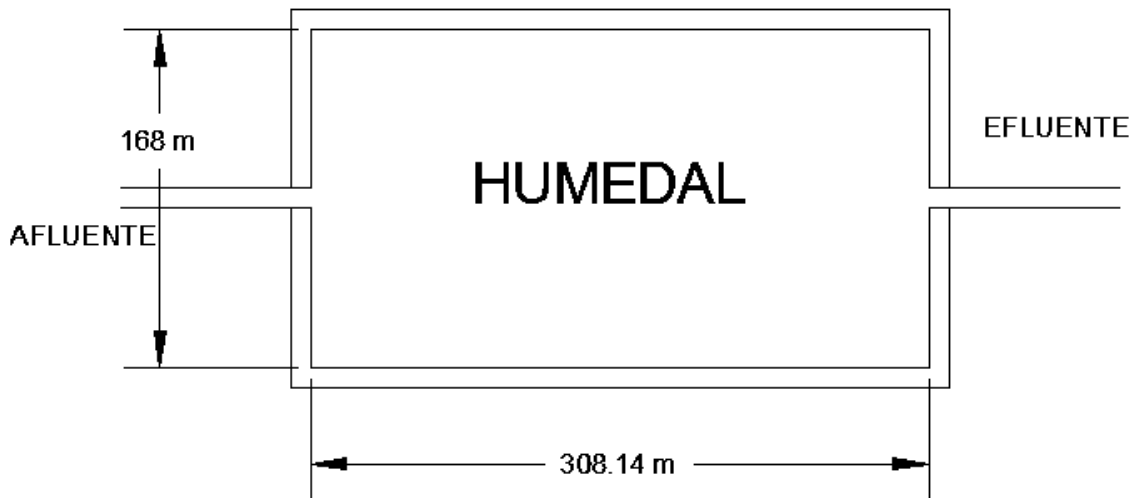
vista en planta de humedal artificial de flujo sub-superficial
